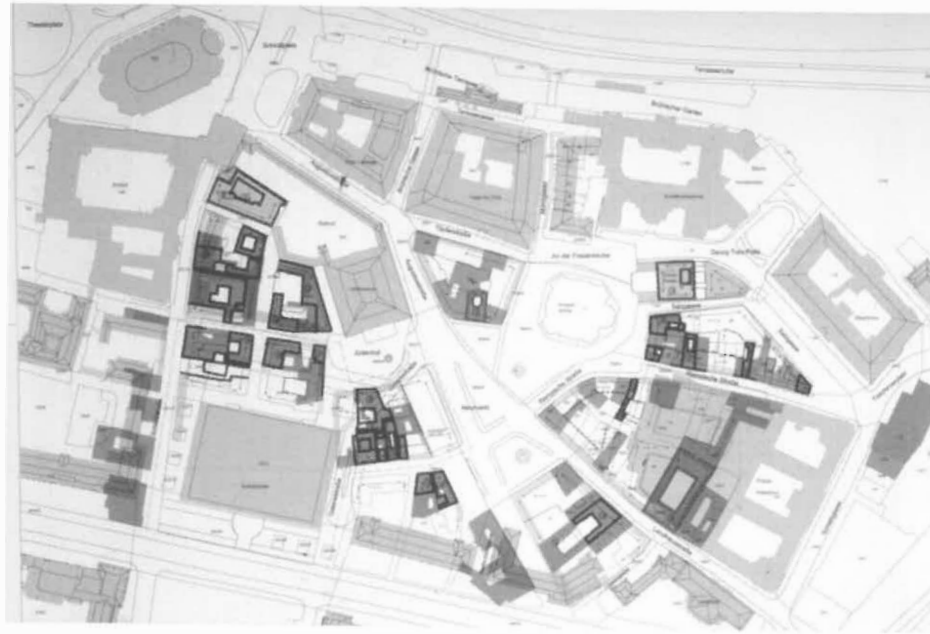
Lageplan mit wünschenswerten Rekonstruktionen (dunkelgraue Flächen), Stand 2001.
